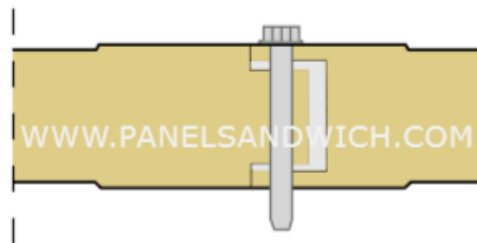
Montaje de los paneles Sandwich en la fachada
